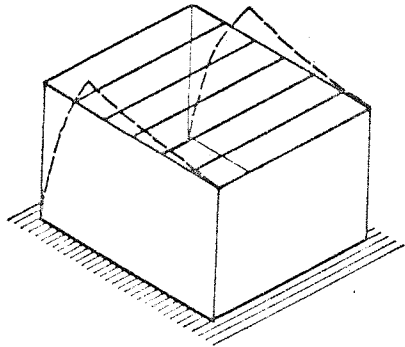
Vinculación entre los planos verticales debida a "techos no rígidos"
